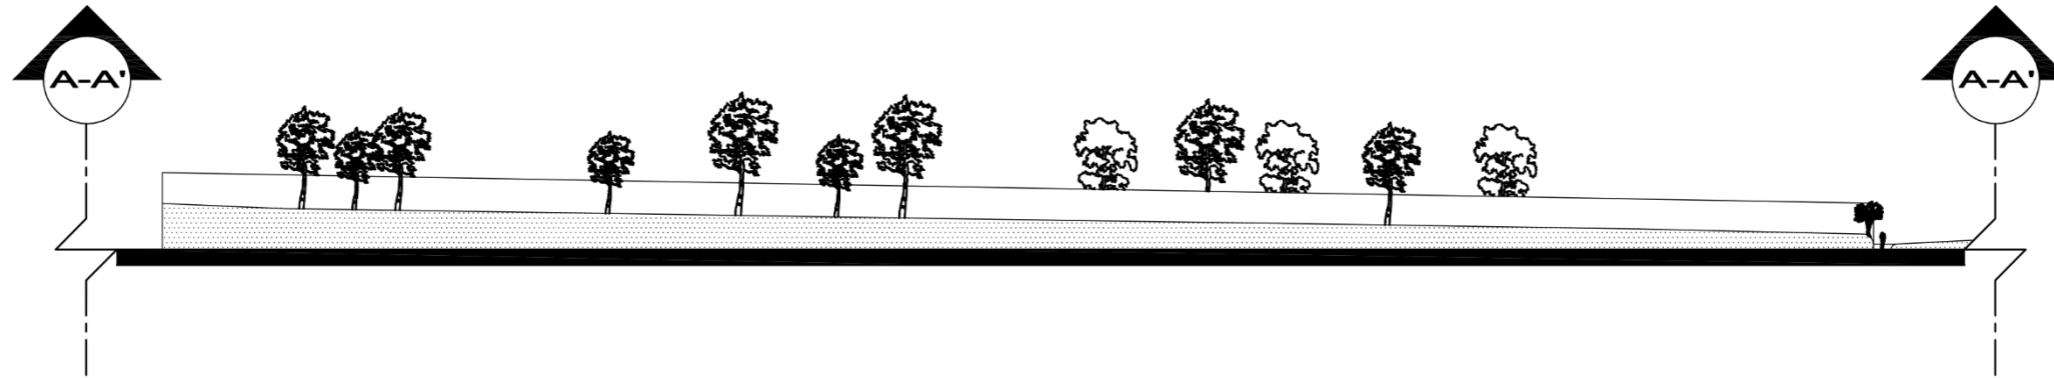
Plano de la topografía del terreno . (Elaboración Propia).
